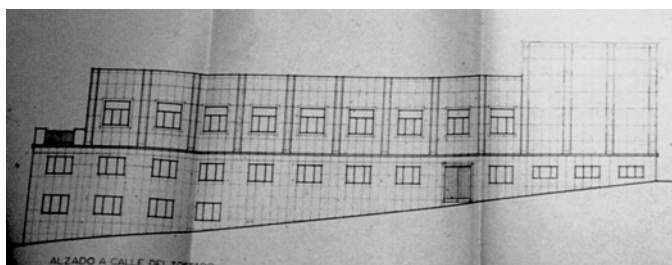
C. M. Santa María de los Ángeles: alzado a la calle del Tostado, por Fernando Población, diciembre 1961.
